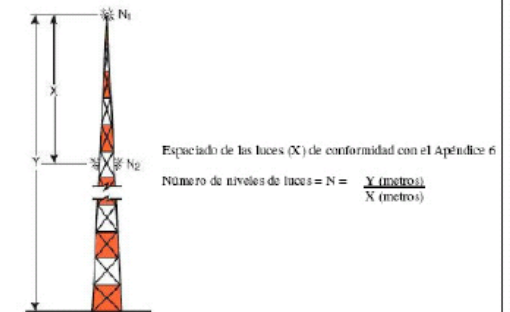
Ejemplos de señalamiento e iluminación de estructuras elevadas
